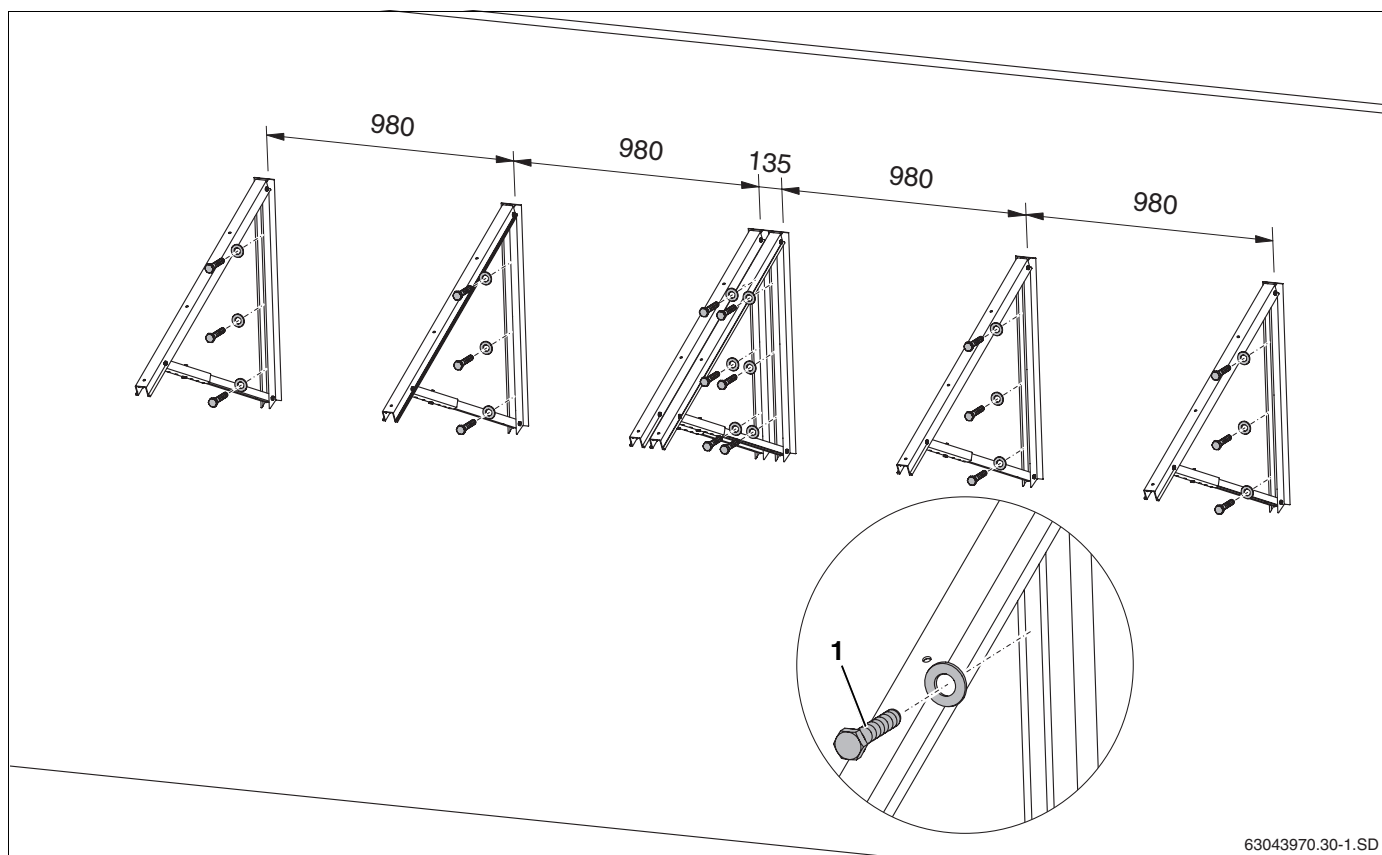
Fixação dos suportes de colector na fachada para 2 colectores (indicações em mm)
